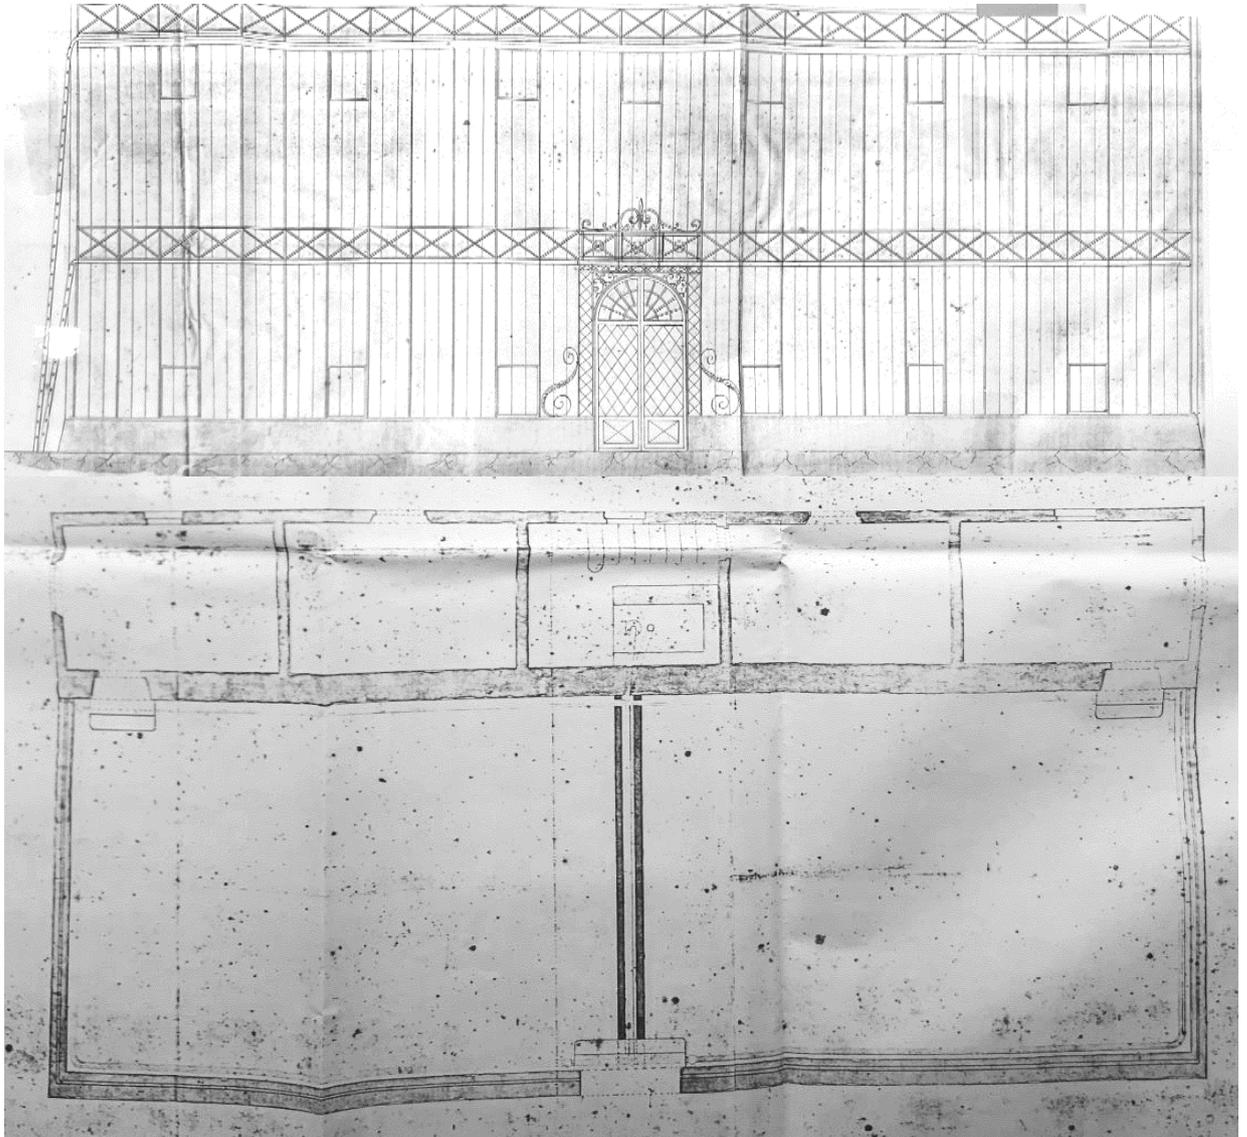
Proyecto para la Estufa Tropical, alzado y planta.* S. MONLEÓN, 1859
